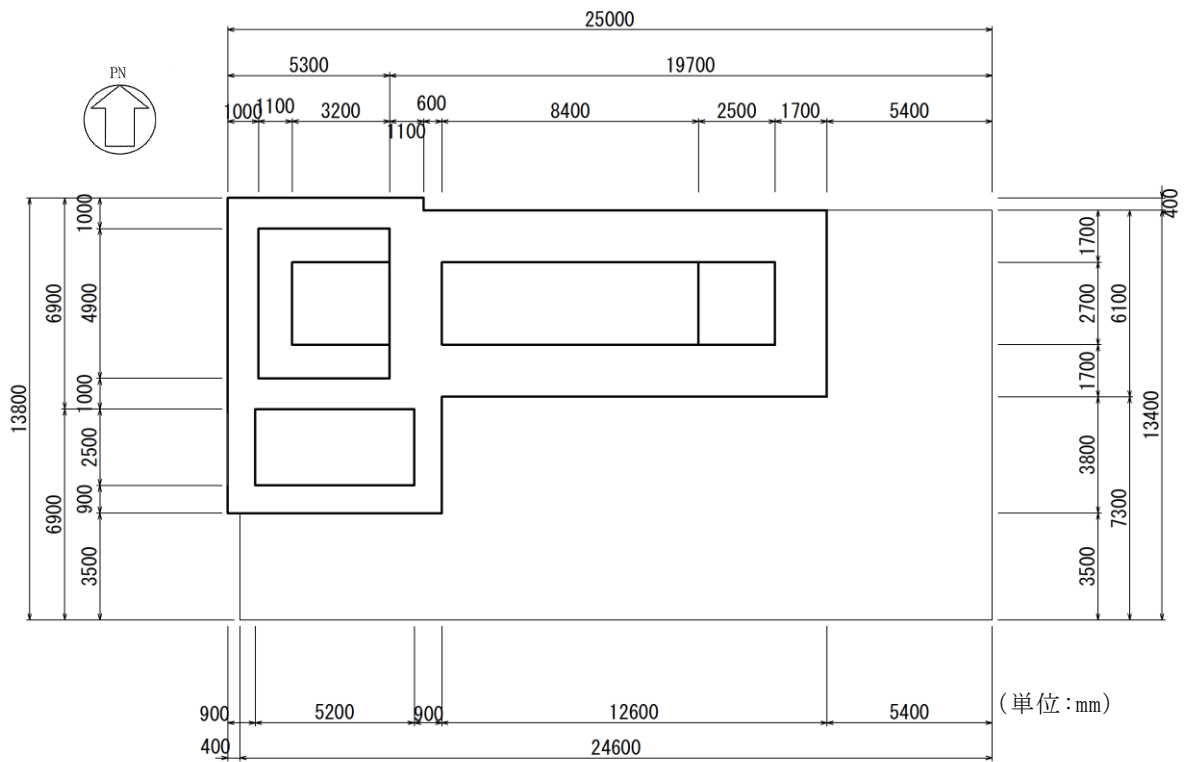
(3) 第 1 ベントフィルタ格納槽 平面図 (EL 16.00m)
